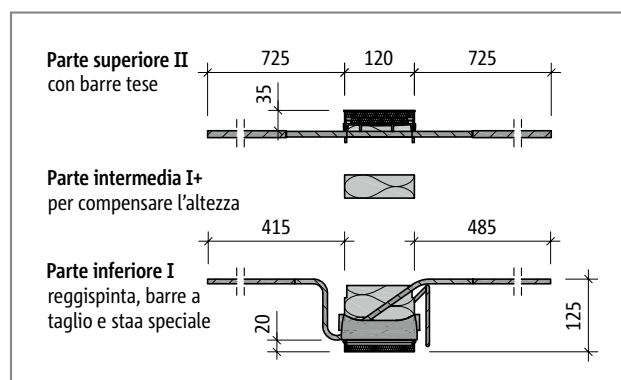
Schöck Isokorb® XT tipo KL-F-M7-CV1 – KL-F-M10-V2-CV1
